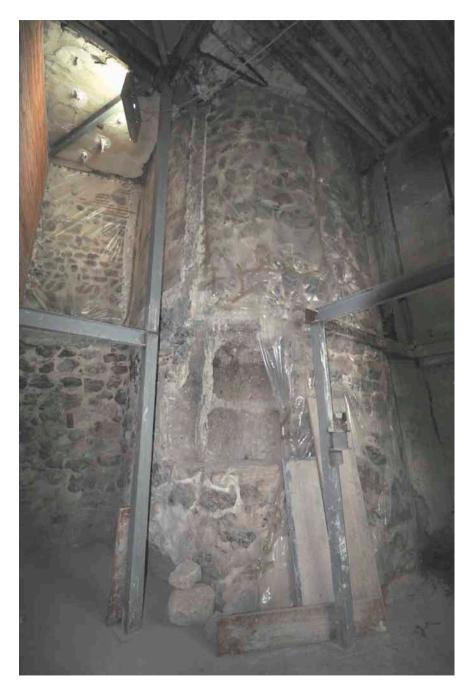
Vista del alzado del torreón y lienzo de muralla en Cava Baja 4.
